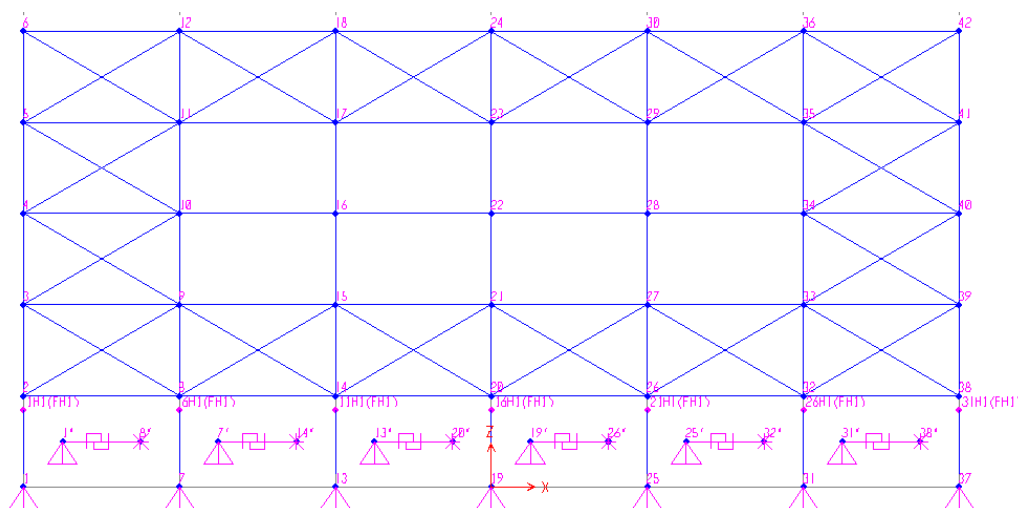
Disposizione delle cerniere plastiche nel modello con SAP 2000.
